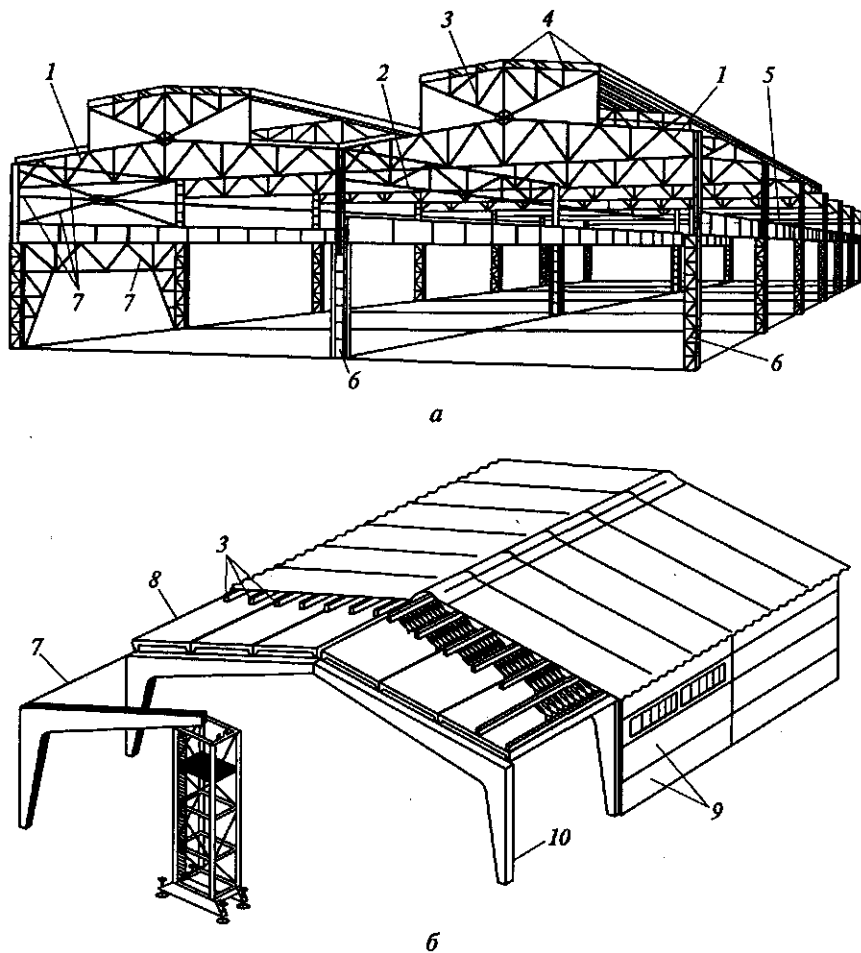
Конструкции одноэтажных промышленных зданий:
